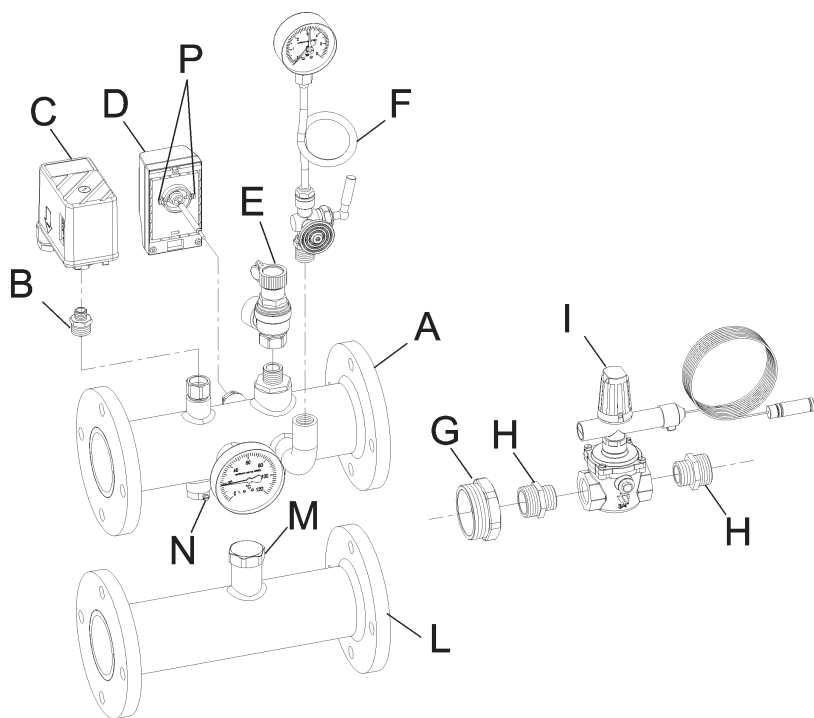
Collegamento dei dispositivi di sicurezza richiesti dalla "Regola R" emanata dall'ISPEL
